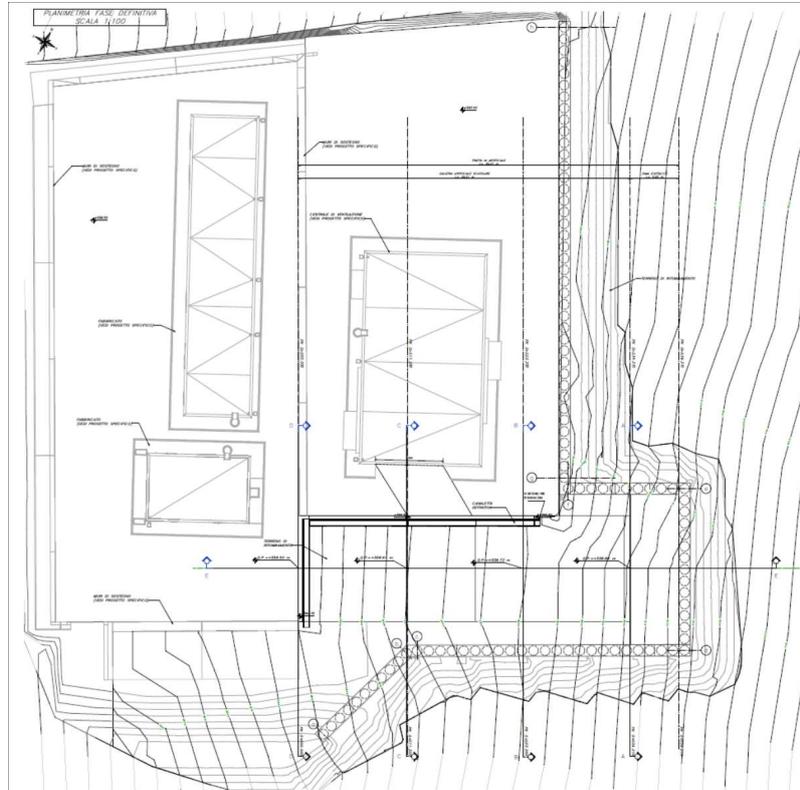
Planimetria delle opere di imbocco della galleria Hirpinia - Finestra F1 – Configurazione definitiva
